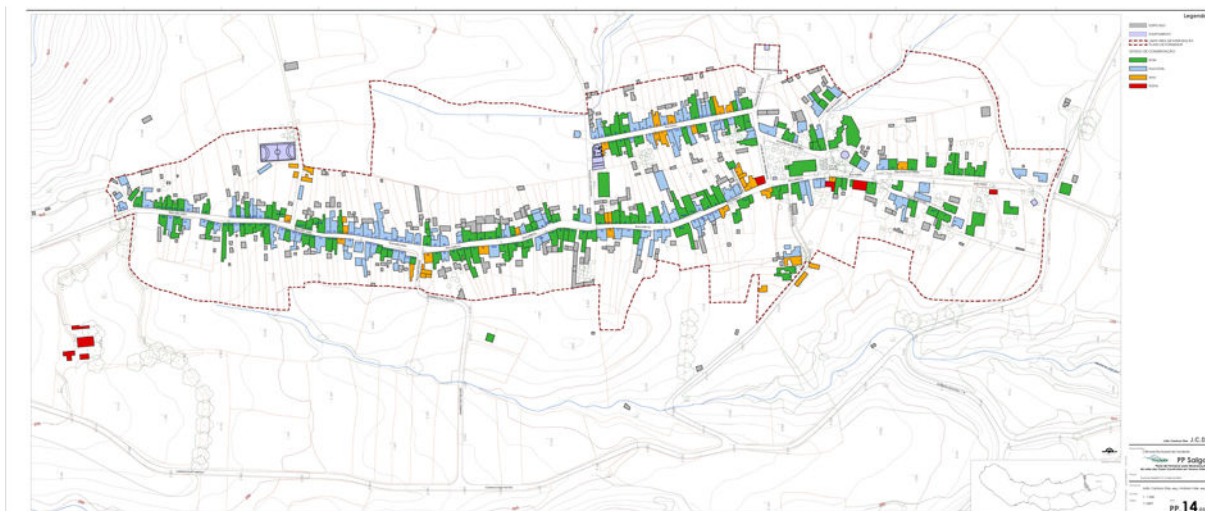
Planta Estado Conservação (ver planta PP.14.03)
